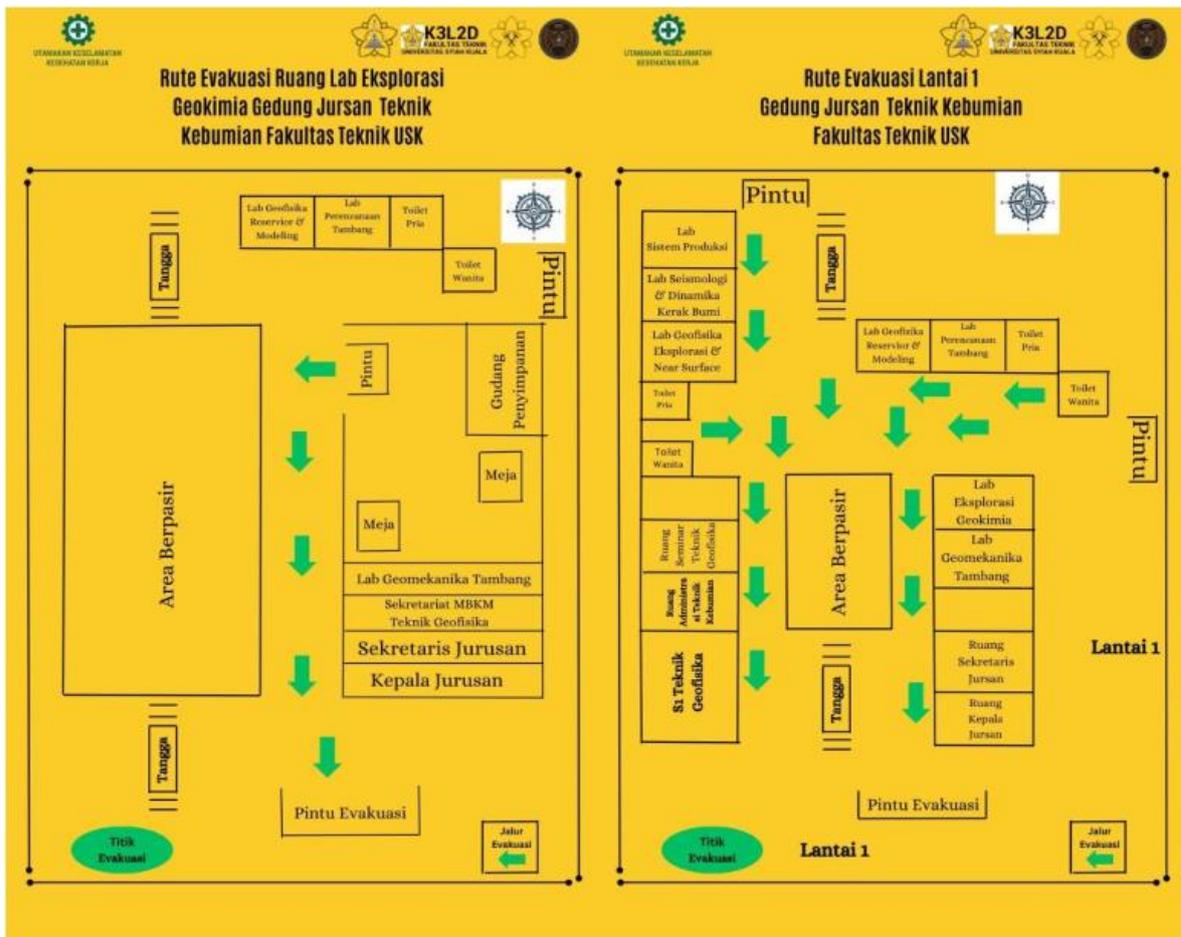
Denah *Escape Route* Laboratorium Geomekanika Tambang
